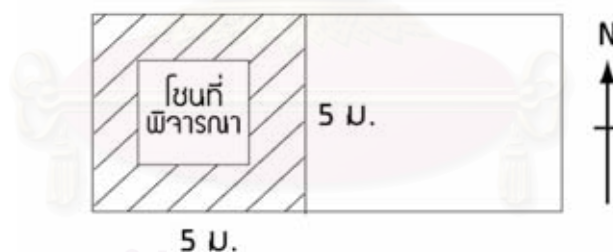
Floor Plan แสดงลักษณะของโชนตัวอย่างที่ 3
